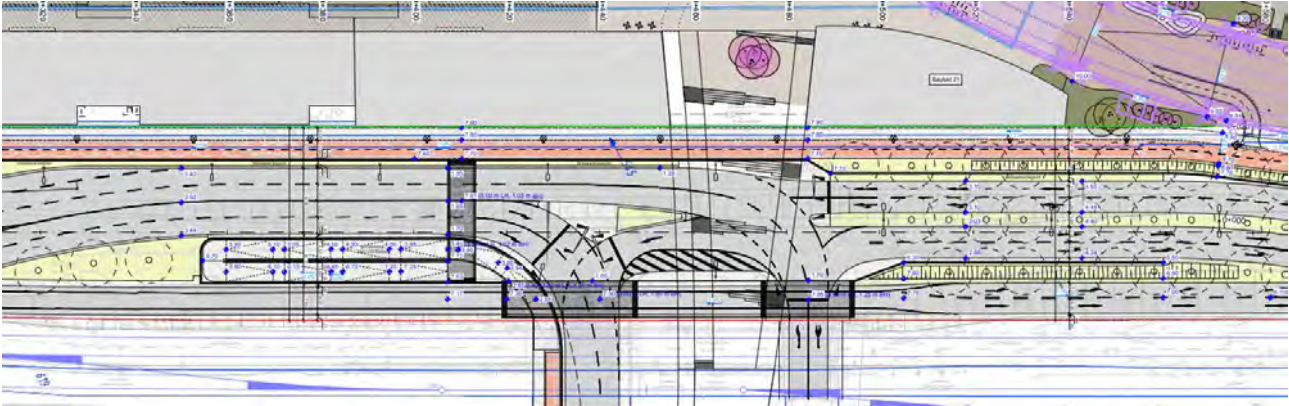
Konzept Knotenpunkt Rampenstraße (Nord)/Tunnelstraße/Am Bahndamm/Rampenstraße (Süd), (ARGUS, Stand: 02/2025)
